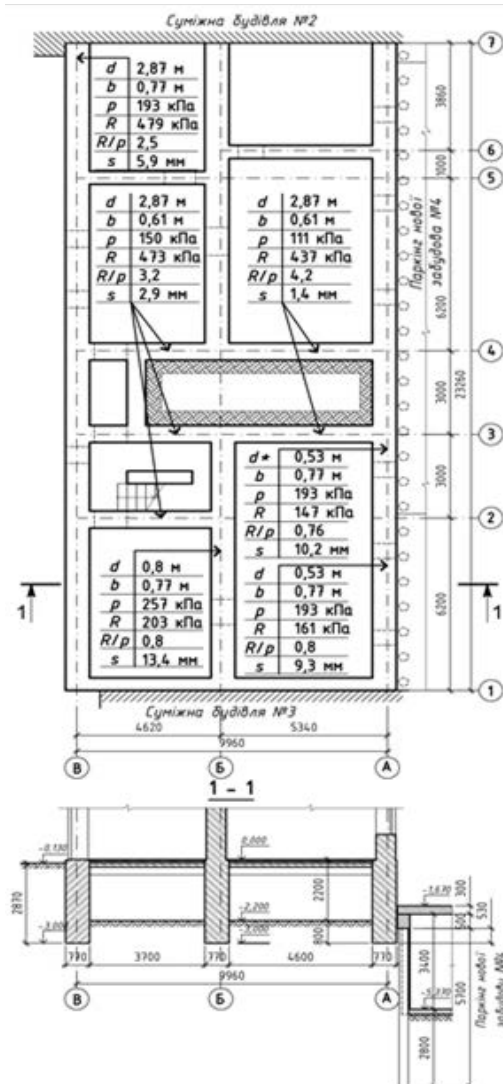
План фундаментів із поперечним перерізом та результатами перевірних розрахунків на етапі виконання будівельних робіт
